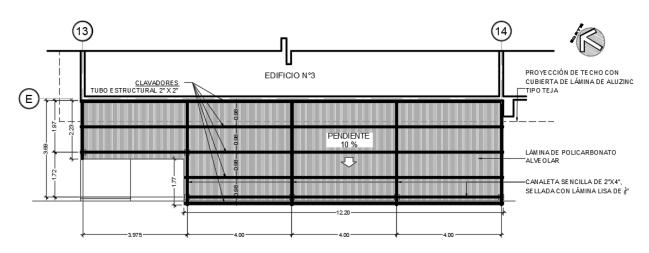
Planta de techo en Atención al Público, Edificio N°3
